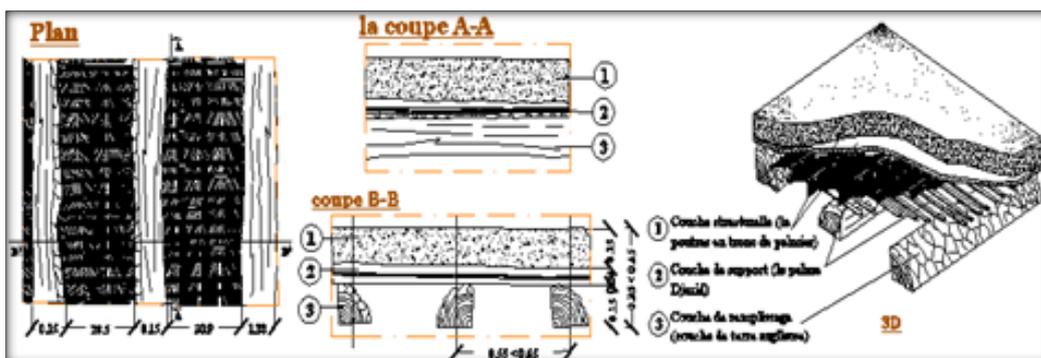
Détails constructif d'un plancher traditionnel. Source : auteur
